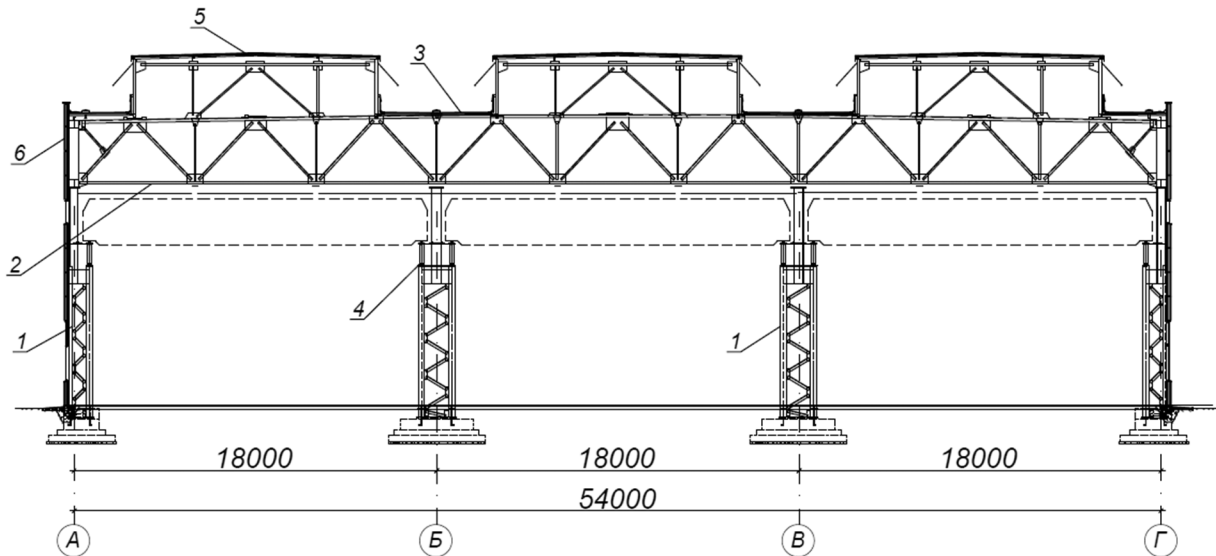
Схема одноэтажного здания со стальным каркасом:
